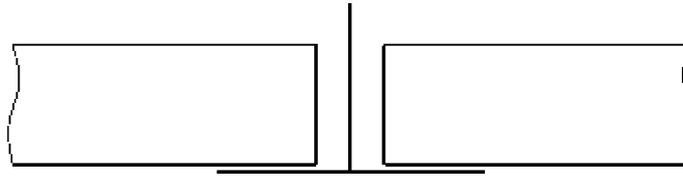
Gips-Deckenplatten mit rechtwinkliger Kante
